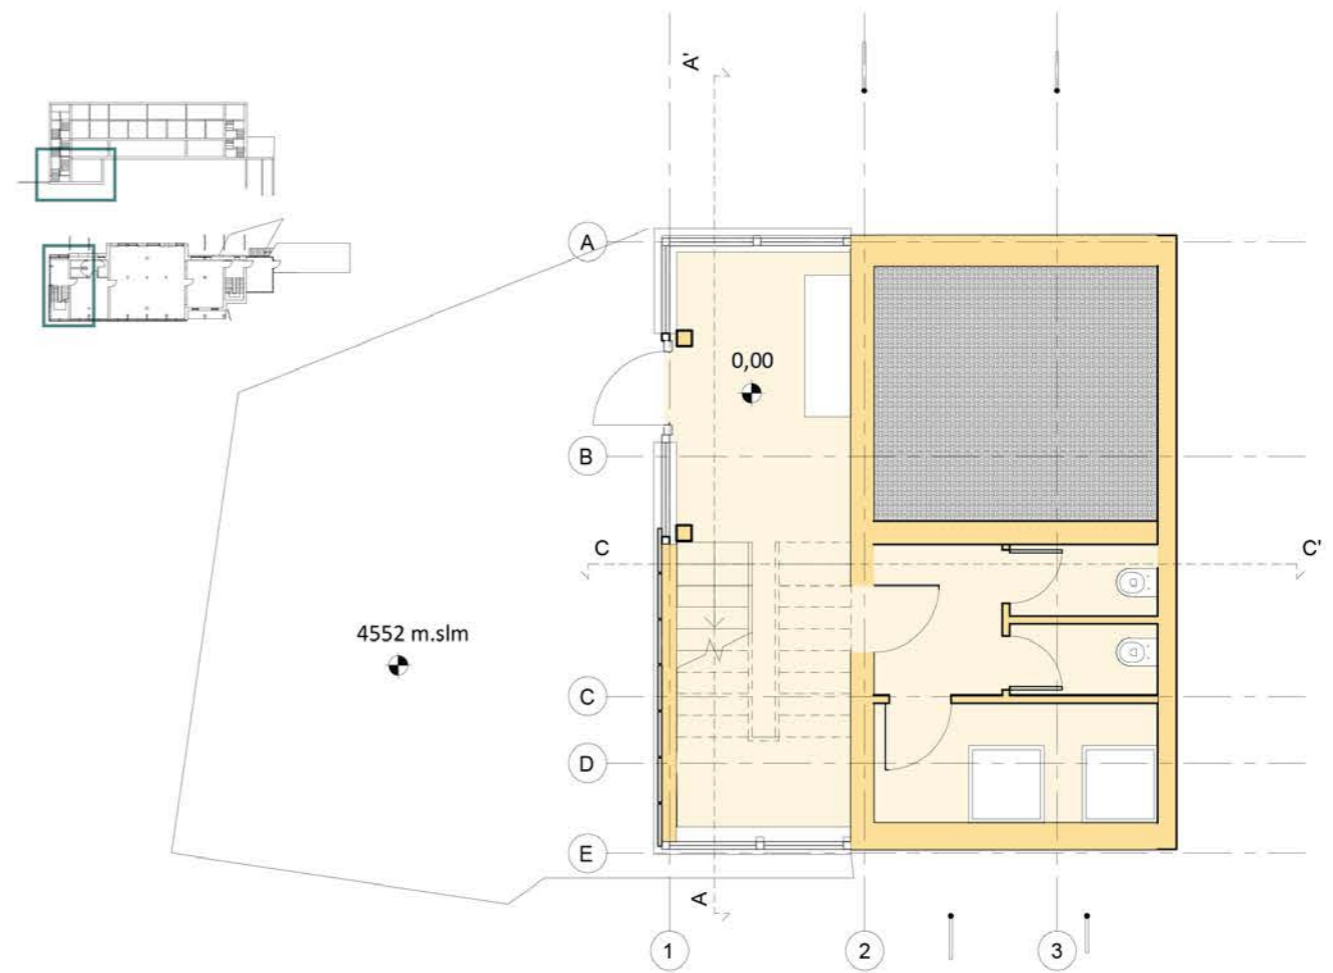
Pianta piano d'ingresso scala 1:100.
